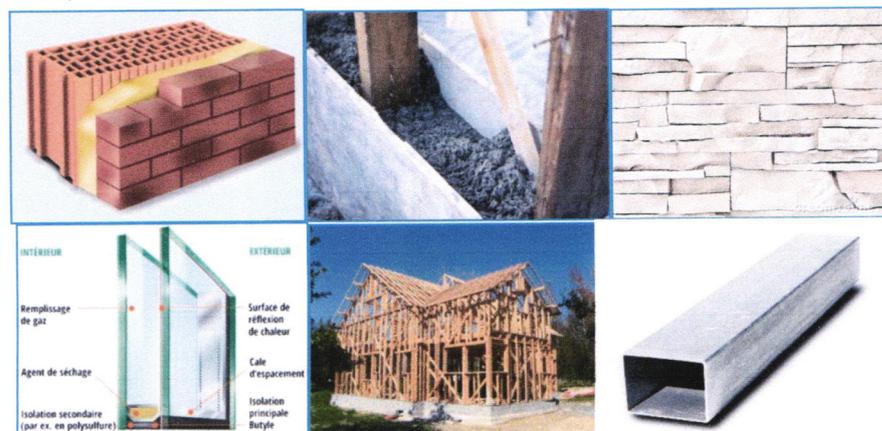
brique monomur, béton de chanvre, la pierre, le double vitrage, structure en bois, acier galvanisé.
